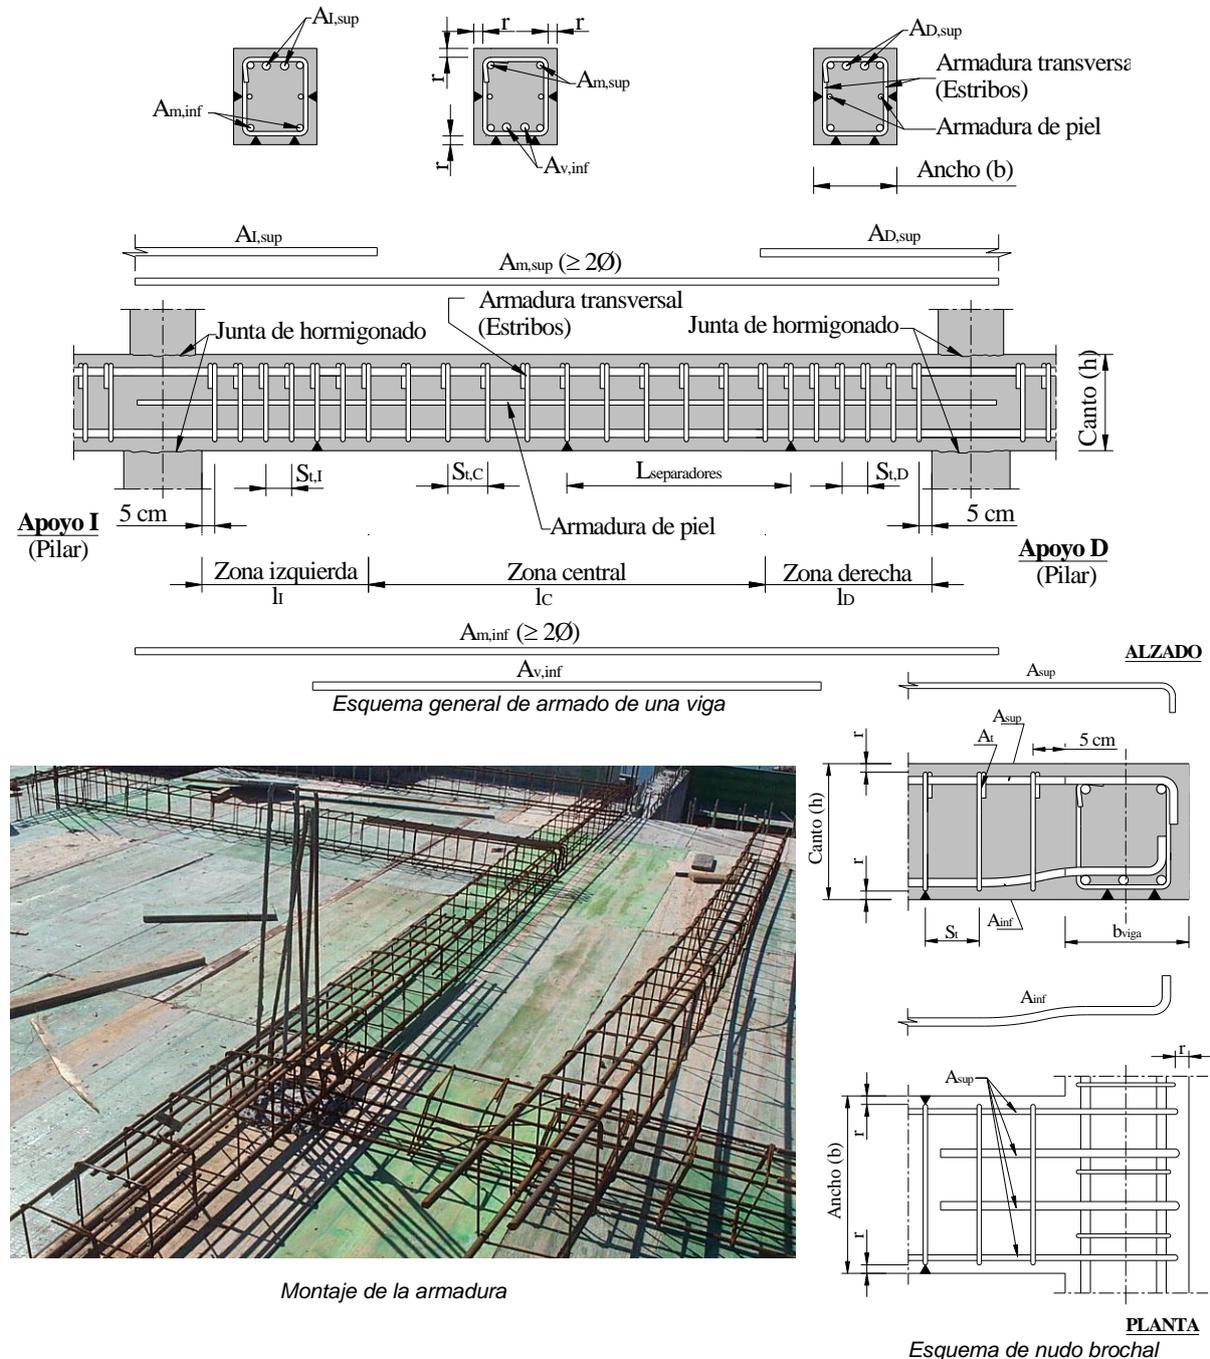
Esquema de armado de vigas y su montaje (Puede visualizarse un armado típico en el siguiente link: <https://skfb.ly/oyEtZ>)
